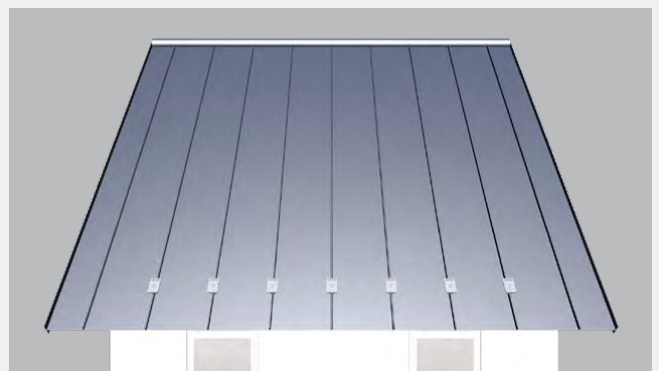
, Stehfalzklemmen horizontal in erster Reihe montiert
